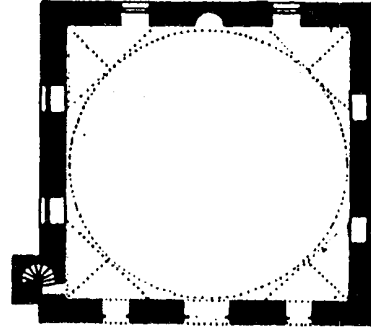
مسقط أفقي لجامع السلطان سليم الثاني في قره بينار (عن : kuran)
